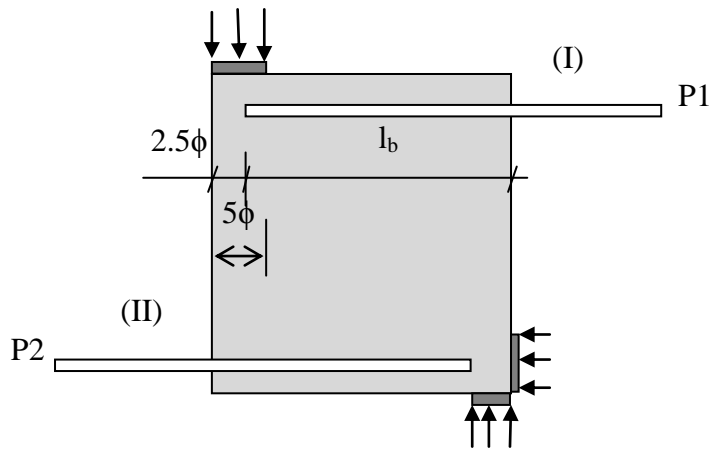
Donatı – beton aderansının belirlenmesi için kullanılan İngiliz Standardı deney düzeneği
